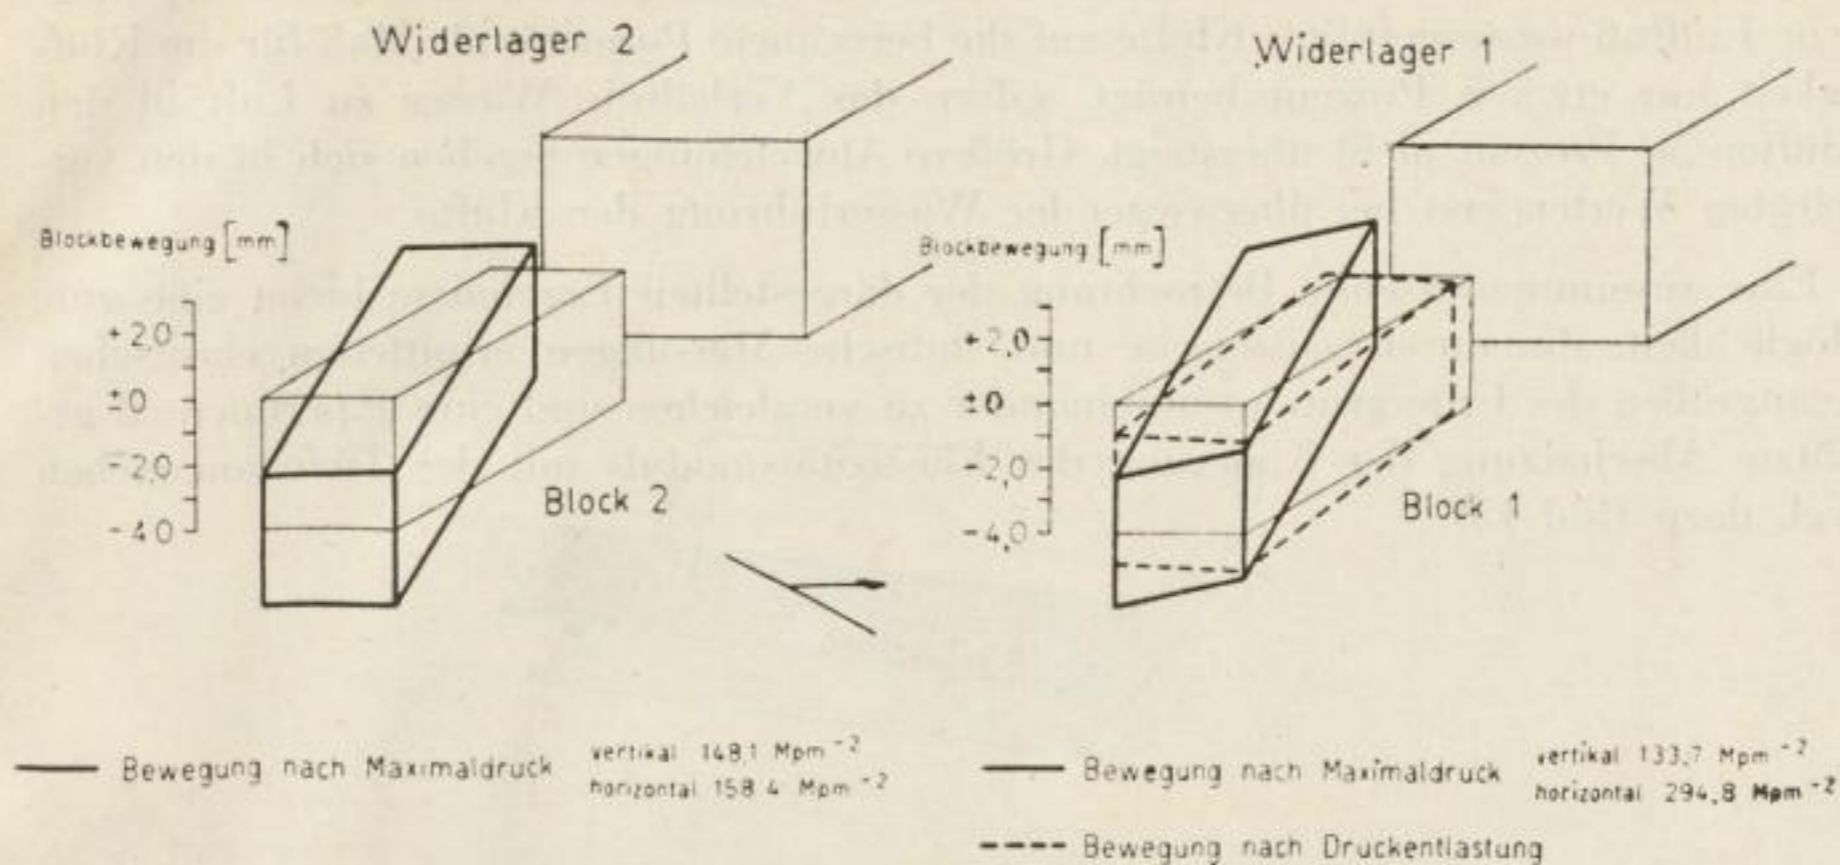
Raumdarstellung der im Untersuchungsbereich Rauschenbach abgescherten Versuchsblöcke B₁ und B₂ einschließlich der Senkungsflächen nach aufgebrachtem Maximaldruck und nach Druckentlastung
